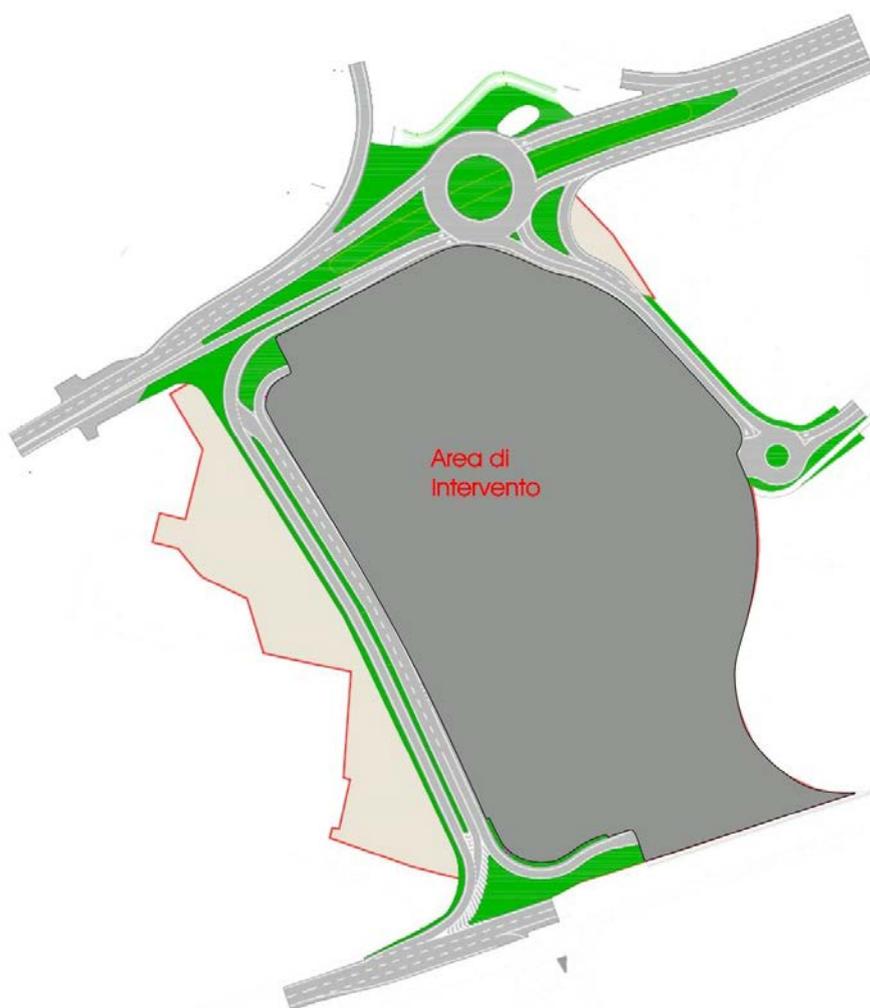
Interventi viabilistici previsti – Ipotesi 1 – Planimetria di progetto
